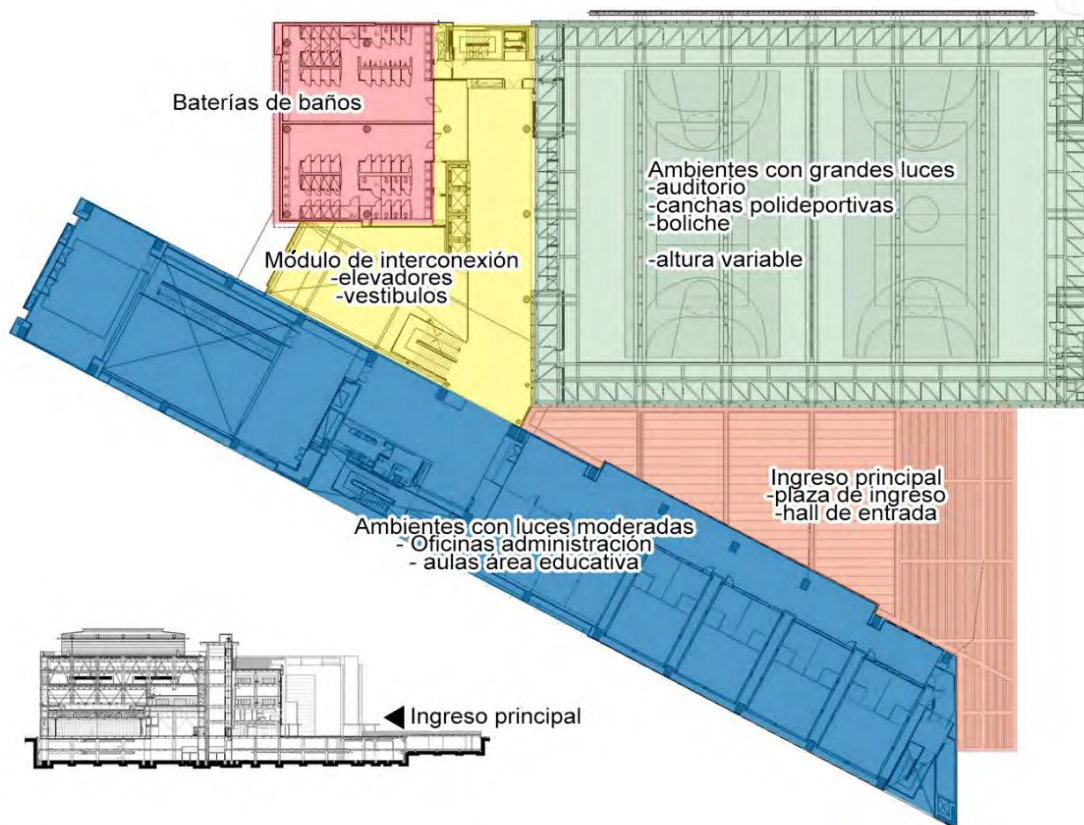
Planta de distribución centro deportivo y cultural El Cubo, Bogotá.
